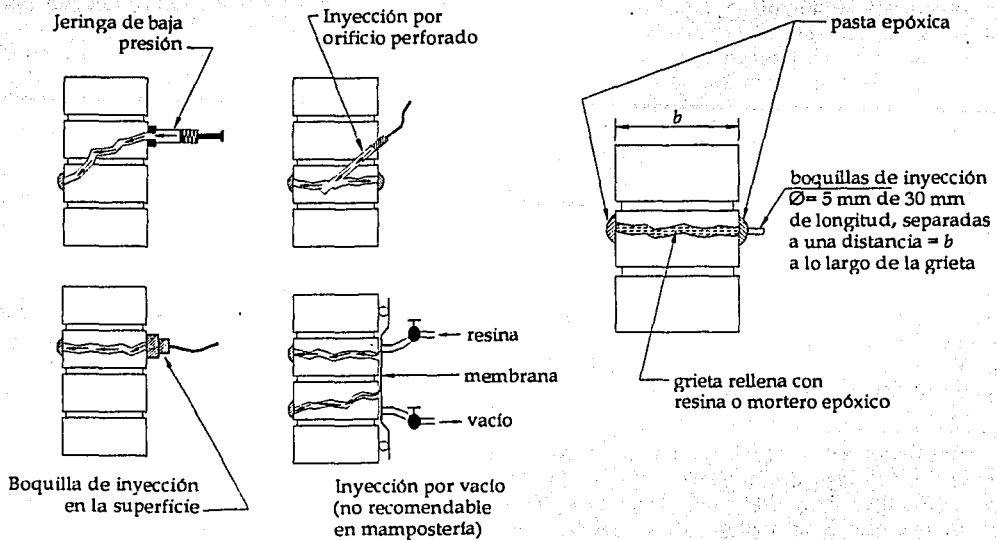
Técnicas de inyección de resinas en estructuras de mampostería.
